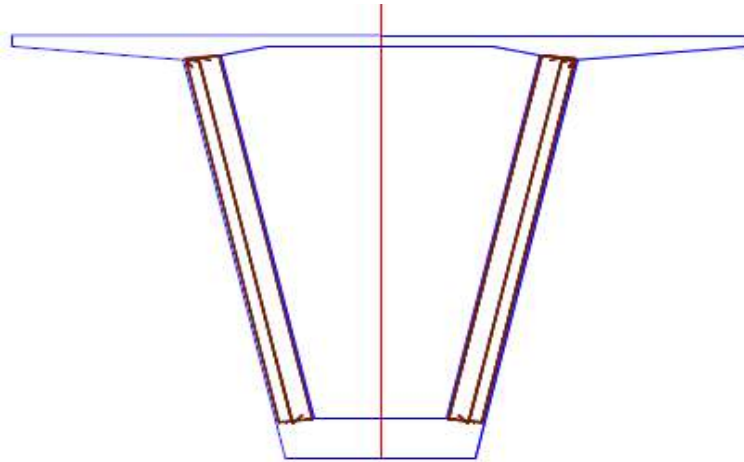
Armatures transversales (1 cadre et 1 épingle)
